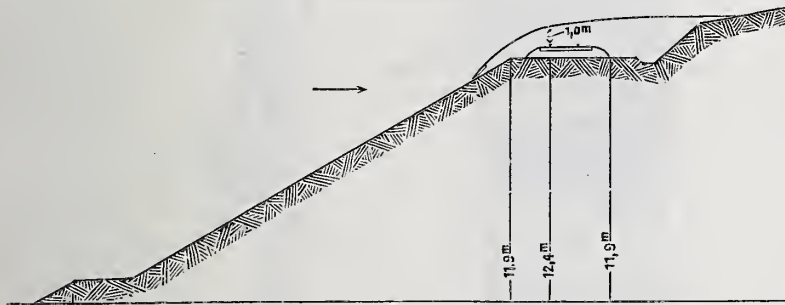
Station 19,9 der Strecke Plau-Rietschenhausen.
